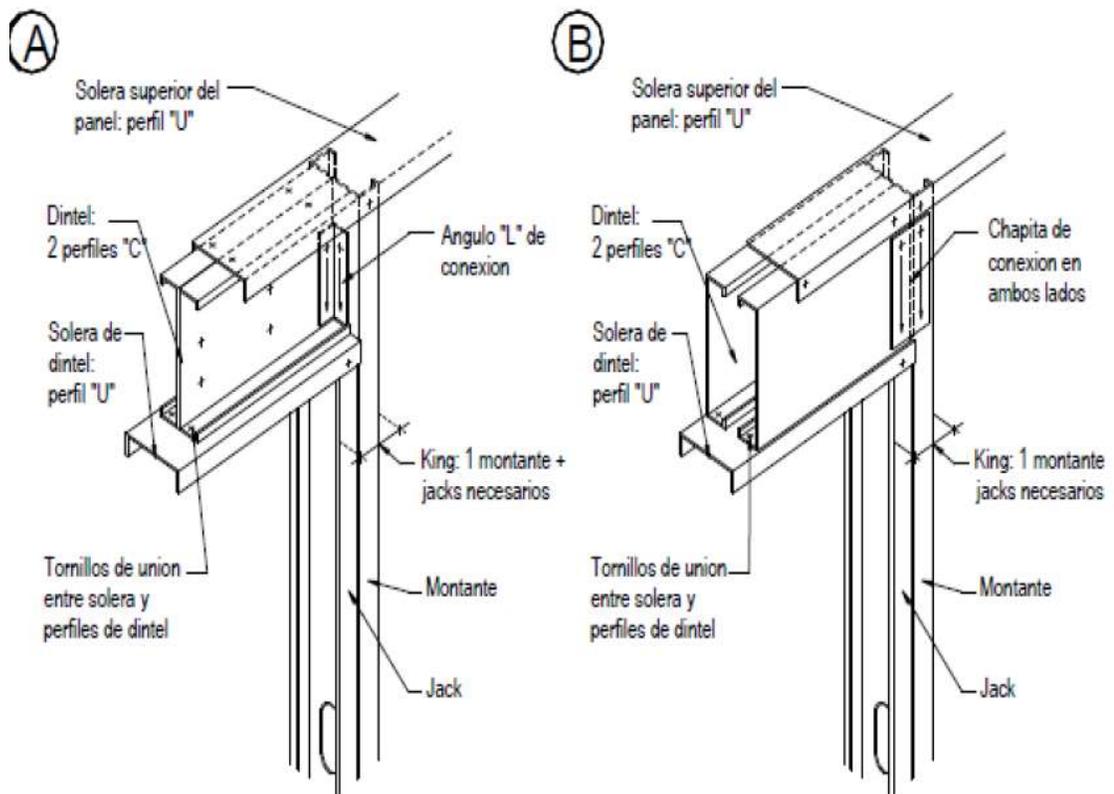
Detalles de piezas pre-armadas para dinteles.
